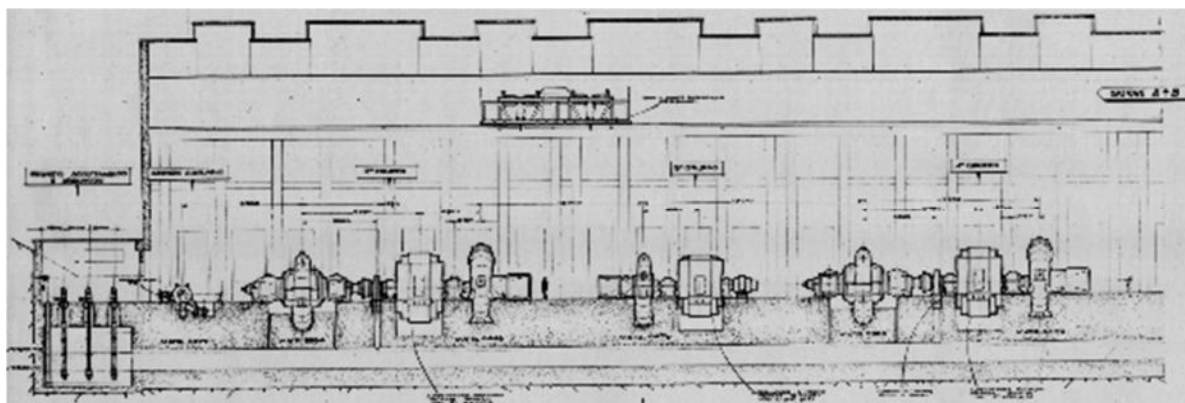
Edificio centrale – Sezione longitudinale. Piano Nr. 128700, agosto 1960
